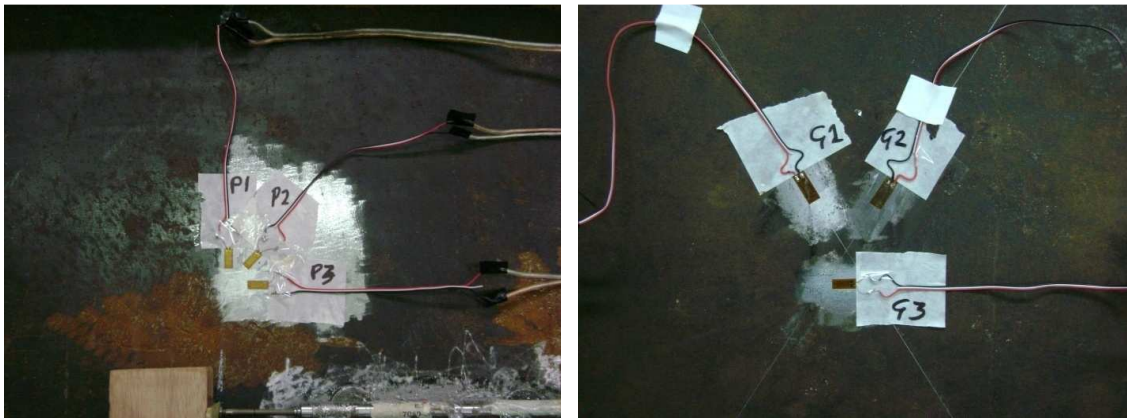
Rosetas de deformación en placas metálicas central y frontal del muro viscoelástico.
